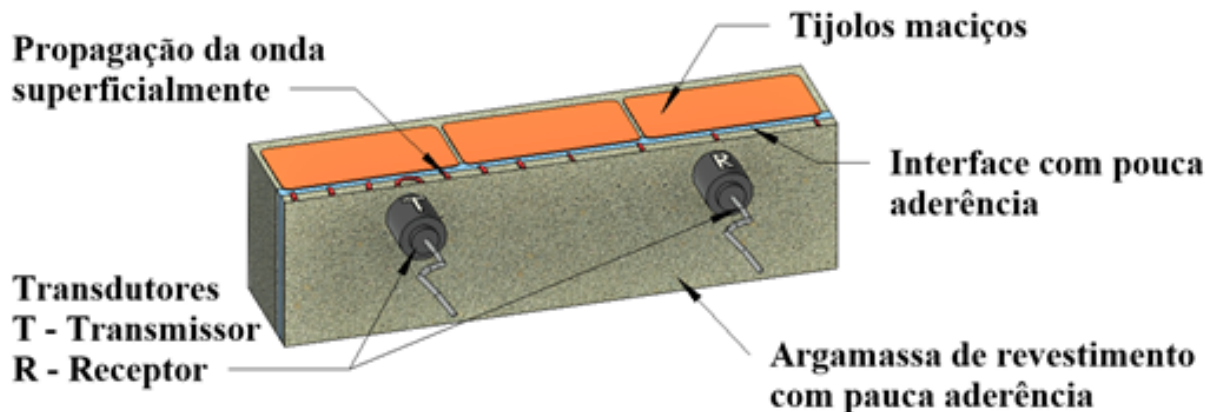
Propagação da onda em um painel com pouca aderência na argamassa de revestimento.
